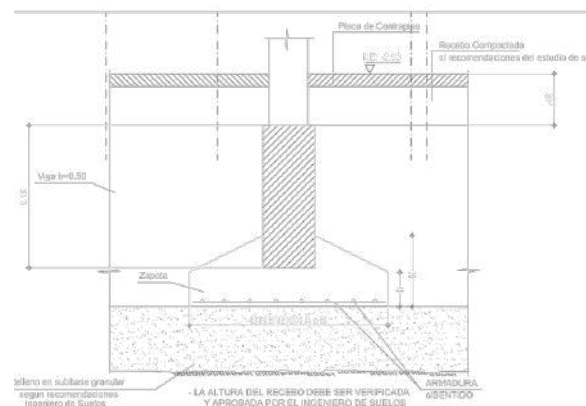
Corte típico de zapatas centradas. Plaza de Mercado IPSA.
